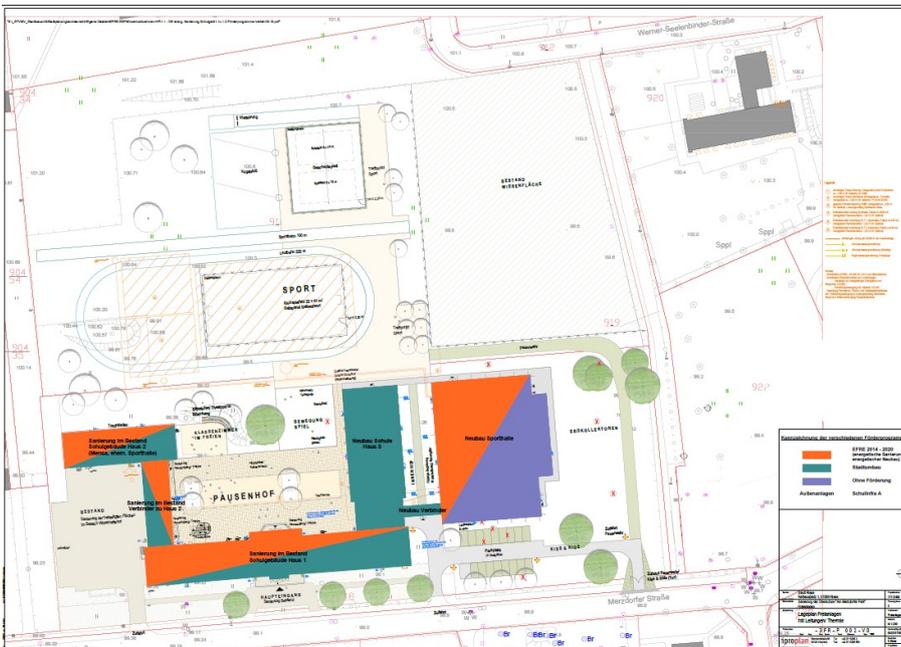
Planung Sanierung und Erweiterung Oberschule „Am Merzdorfer Park“ mit Neubau Sporthalle¹¹
